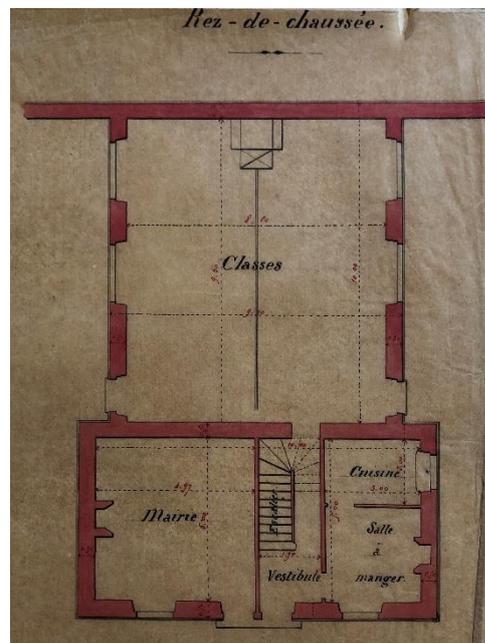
Extrait des plans de construction de la Mairie-École, Archives départementales
